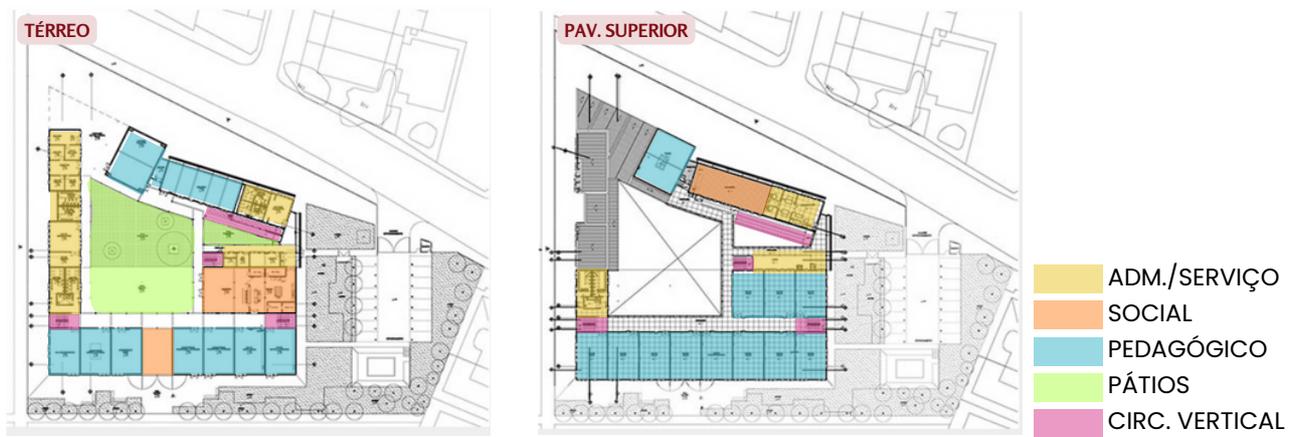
(esquerda): Planta baixa térreo da ETE Cícero Dias, com edição autoral.
